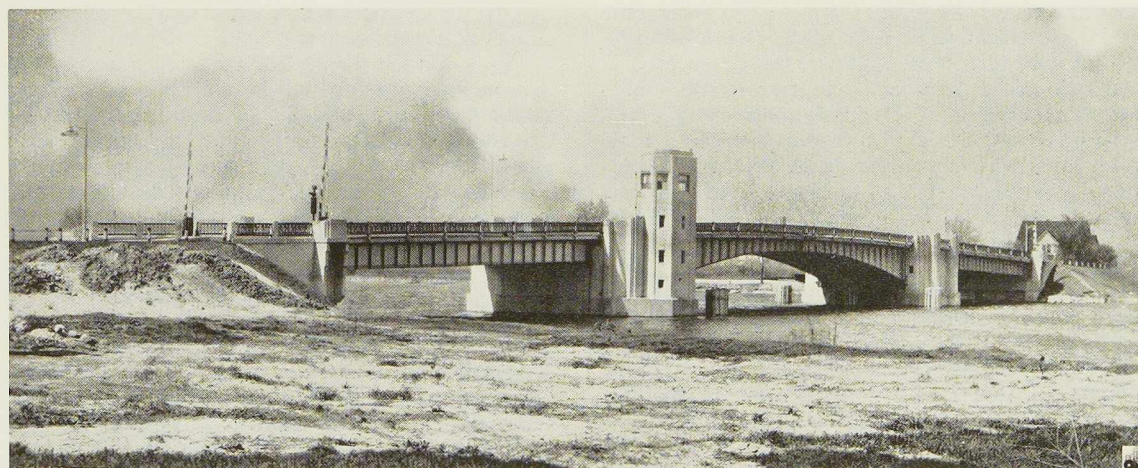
Le pont de Lafayette Avenue sur la Saginaw River (Michigan).
